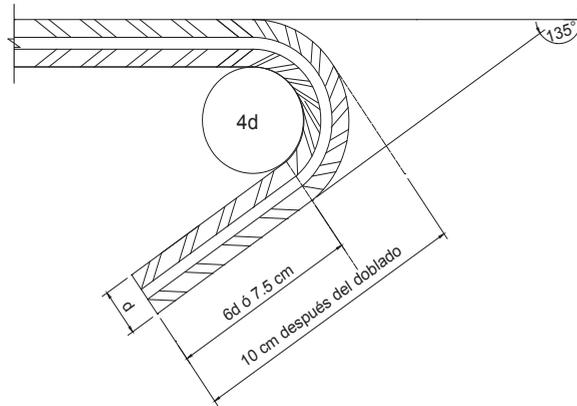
Geometría del gancho Longitud de doblado en estribos de 8mm
